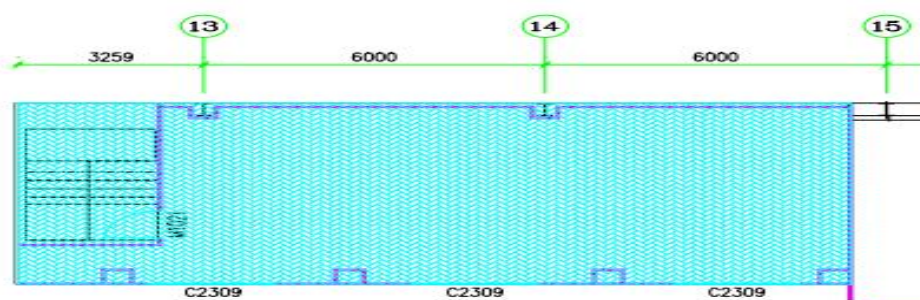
12-16 轴 5-8.5 米吊顶平面图
